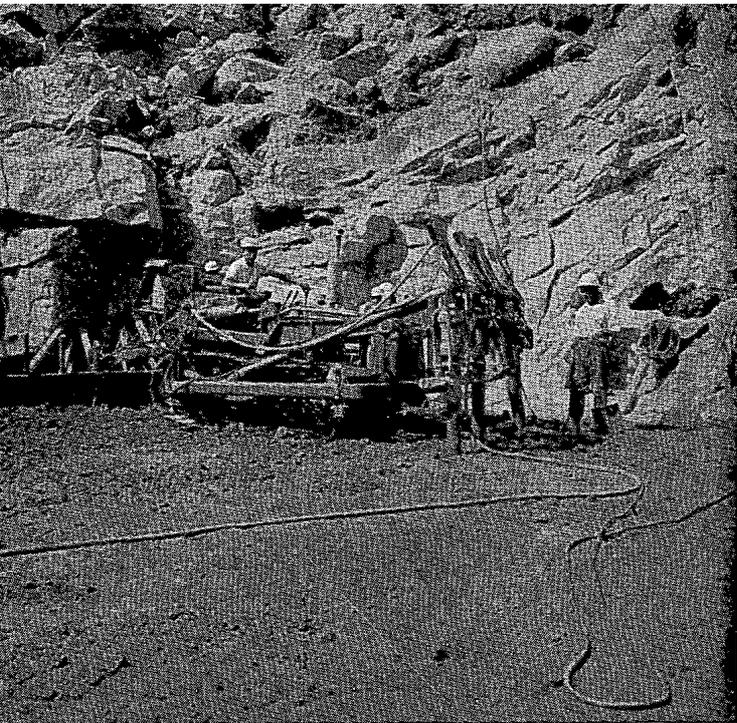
ª — Vibrado mecánico del hormigón en la presa de Almendra.
